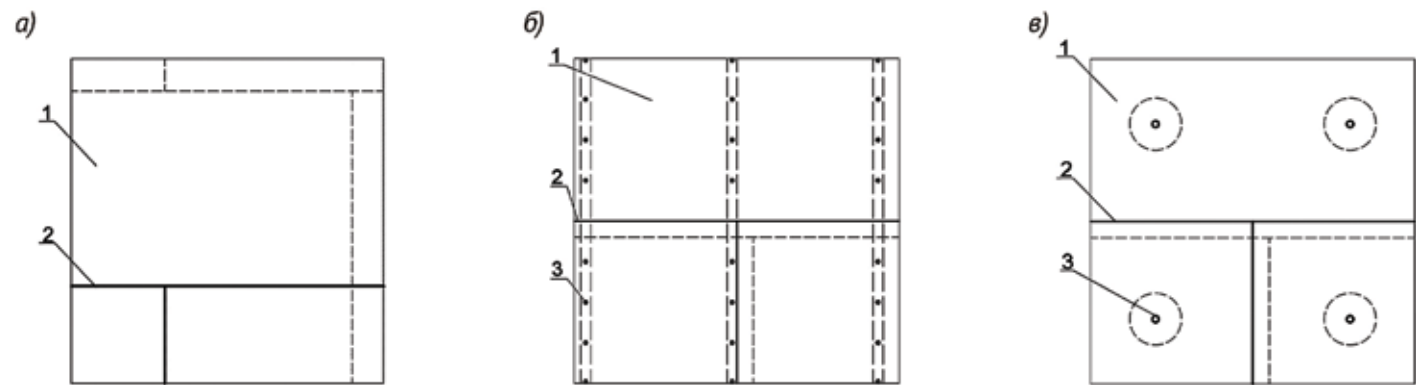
Общий вид фрагментов теплоизоляционного слоя из экструдированного пенополистирола для определения приведенного сопротивления теплопередаче: а) – теплоизоляционный слой инверсионной балластной кровли;
